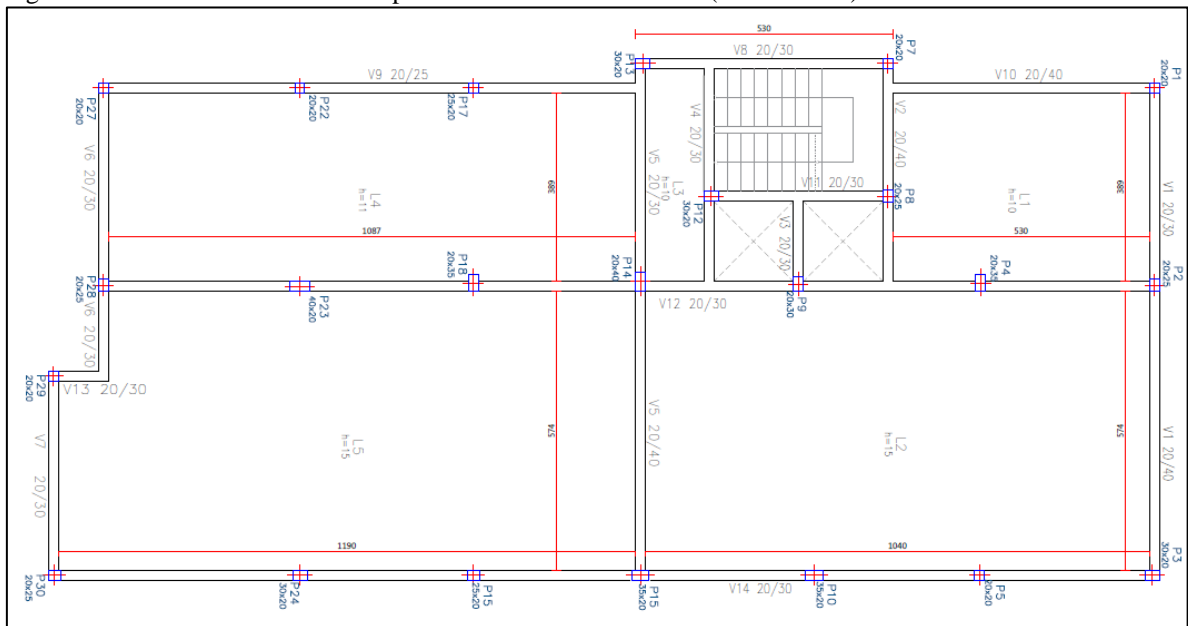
Planta de Forma Pav. Tipo – Modelo 02 – Sem vento (cotas em cm)
